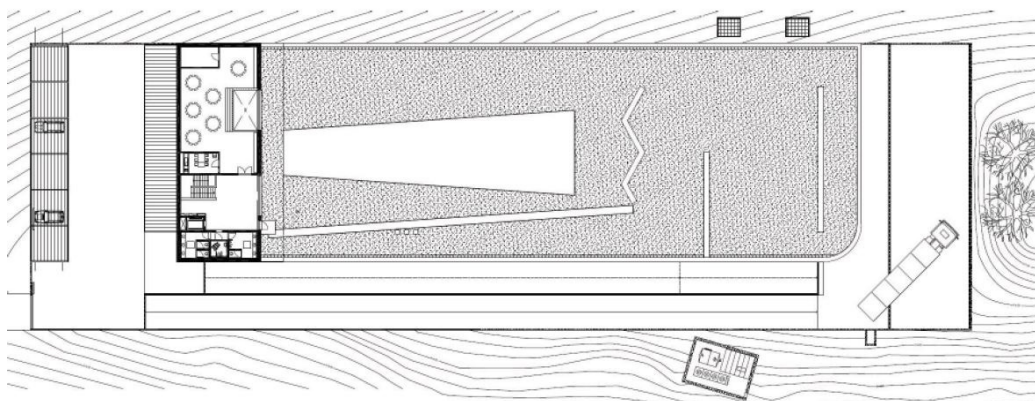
Adega Mayor - Planta do Piso 2²⁸
